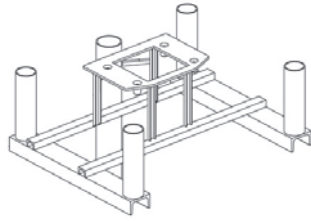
Fundament OPI2020 und Vorbereitung eines Ladepunkts, bei dem das Fundament in das Stahlbeton-Fundament integriert wurde. Die Rohre ermöglichen eine problemlose Installation der Schutzbügel und des Hinweisschilds. Für die Verwendung von OPI 2020 ist es erforderlich, dass die Ladestation über eine Befestigungsplatte mit passend angeordneten Bohrungen aufweist. Wenn eine Station dieses Merkmal nicht aufweist, kann die Installation mit einer Adapter-Zwischenplatte erfolgen. Als Alternative kann auch ein geeignetes Fundament für die ausgewählte Station entworfen werden.
